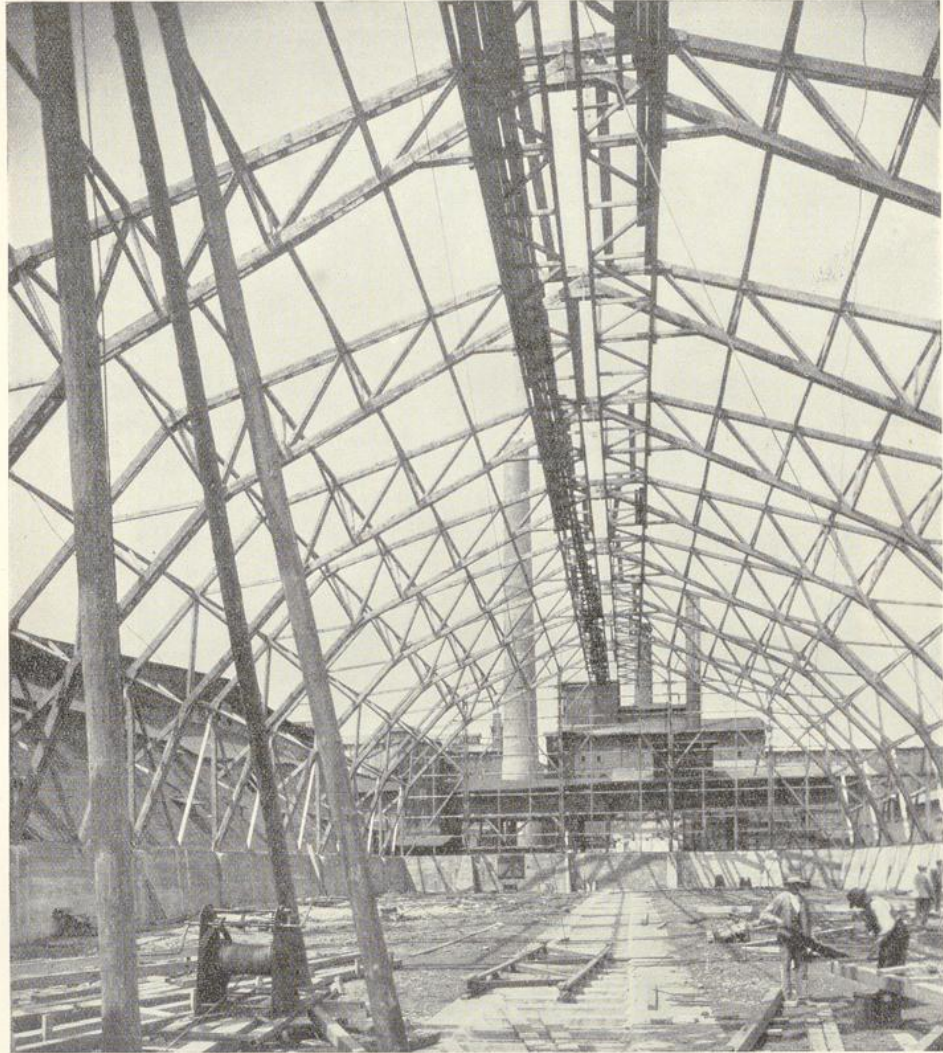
Hallenbau im Holzbau System „Meltzer“. Salzlagerhalle für Kaliwerk Siegmundshall.
